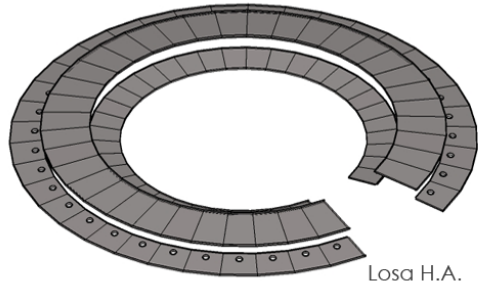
Elaboración propia a partir de planimetría original Casa de Máquinas de Temuco y medidas tomadas en terreno
